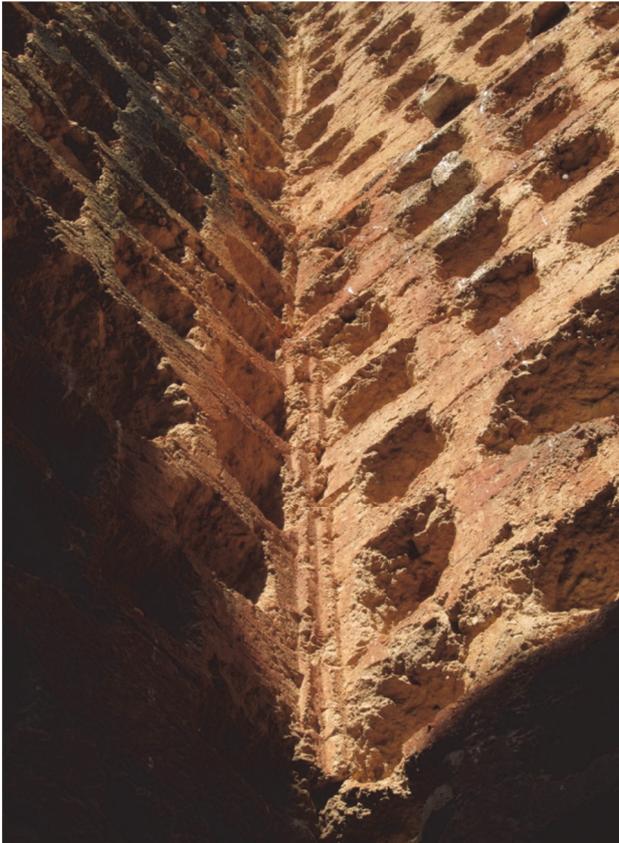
Detalle del encuentro en las esquinas interiores en las que aparece el resalte de la masa del tapial debido a la colocación por el interior de un costal y los tableros atestados al mismo
